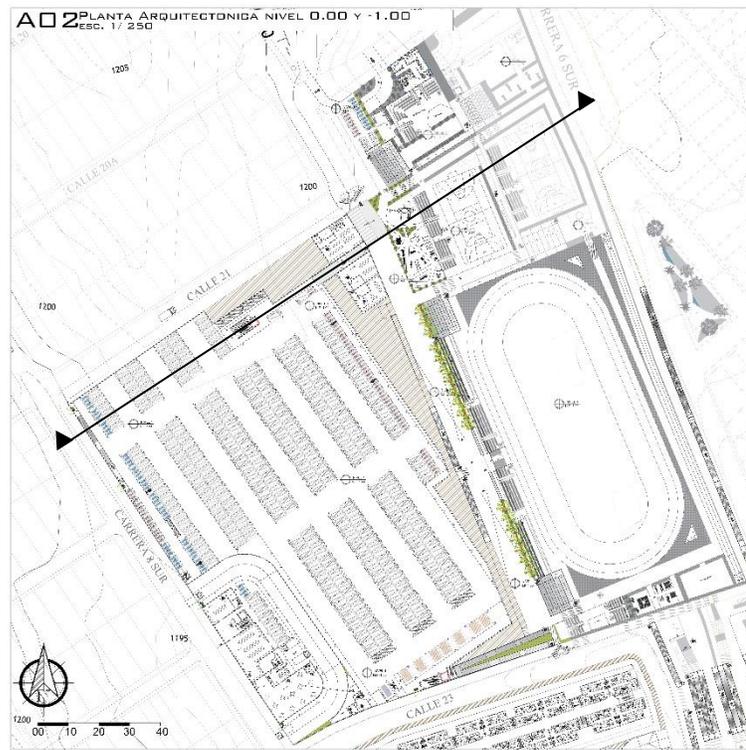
Planta nivel 0.00 y Nivel -1.00- Elaboración propia
